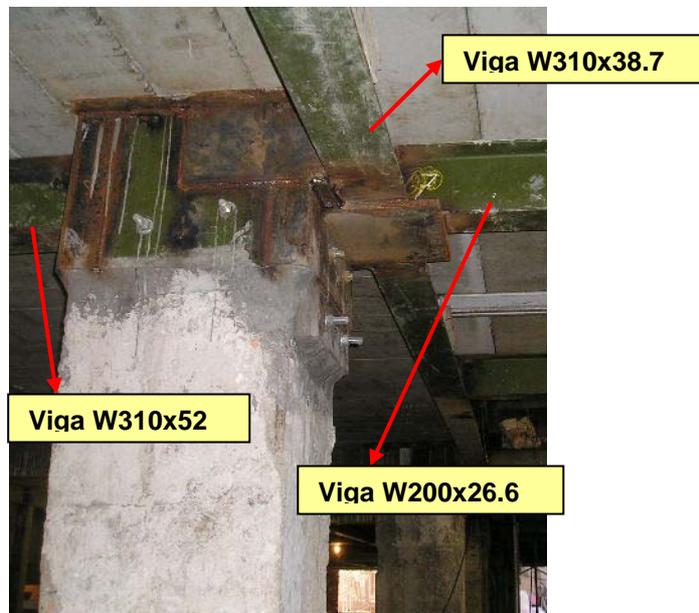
Foto do colarinho e do berço do pilar (arquivo do autor)
